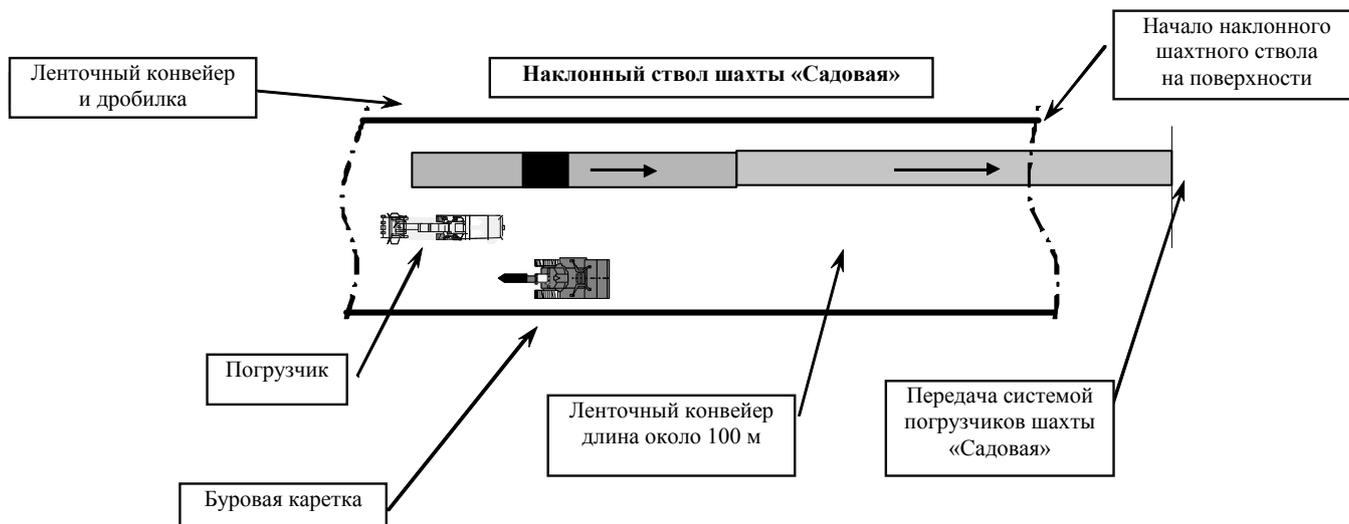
План механизации на этапе подготовительных работ (этап 1)
